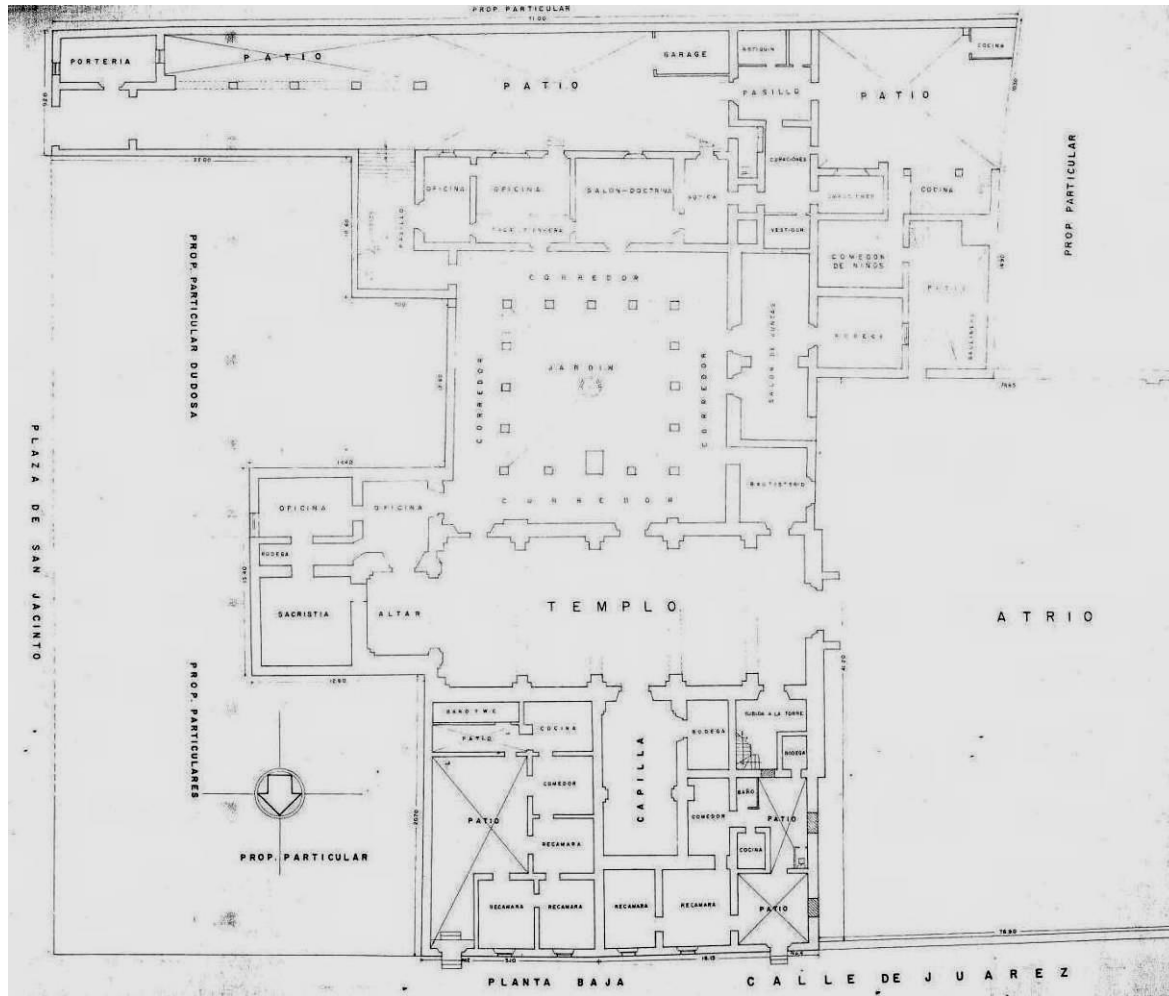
Planta baja del conjunto conventual de San Jacinto Tenanitla, 1945.¹⁹⁸
